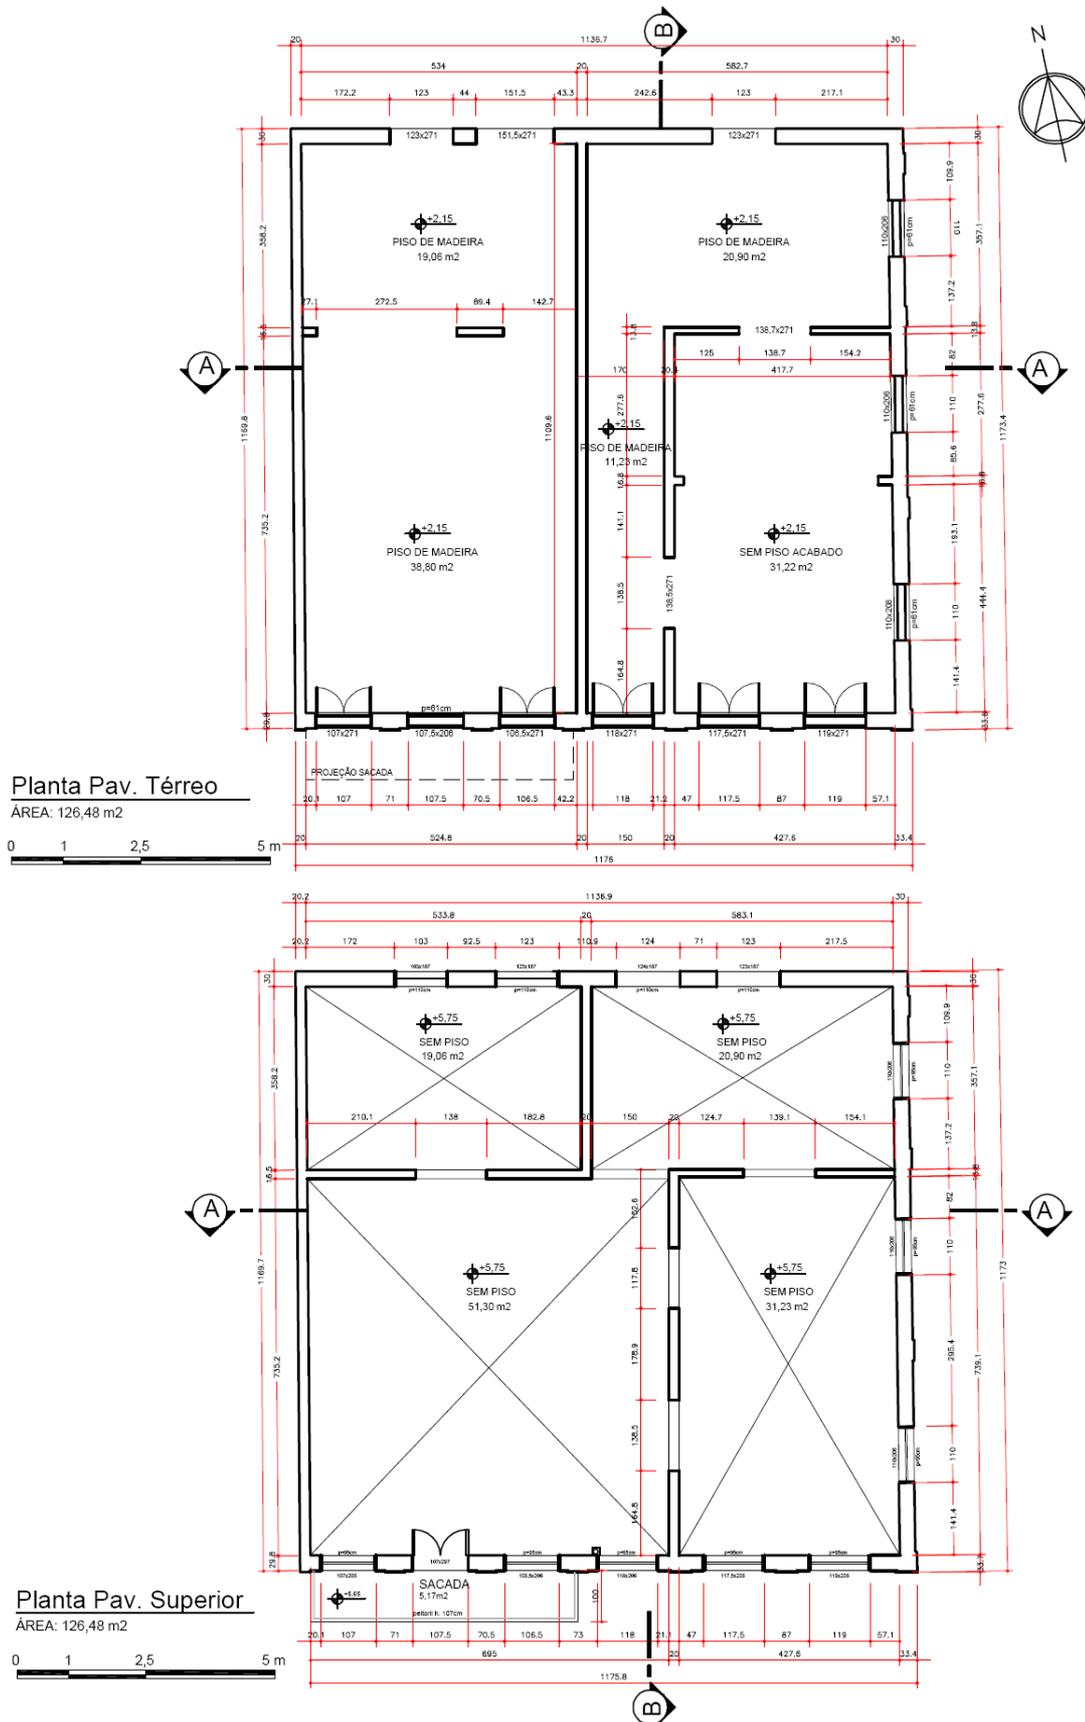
Plantas do Térreo e do Pavimento Superior do edifício existente
